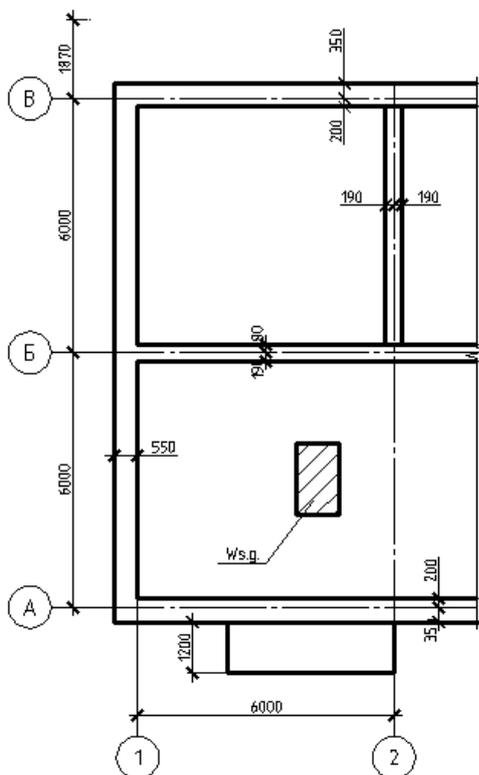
Грузовая площадь стены от снеговой нагрузки
